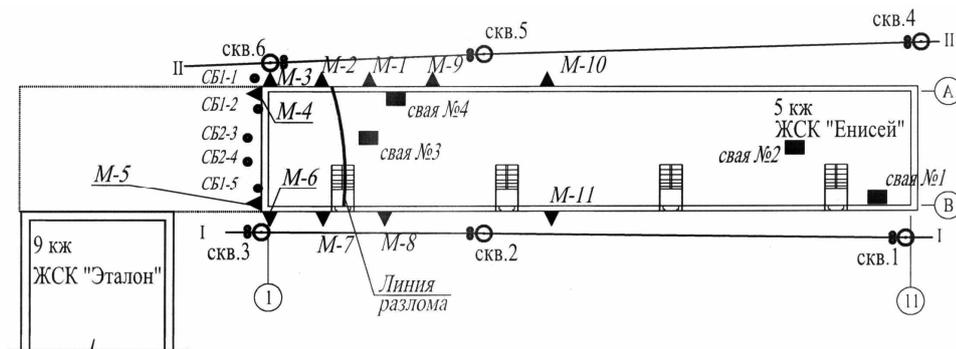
Ситуационный план: ▲ М-1 — места установки осадочных марок; ● СБ1-1 — места расположения буровых свай; ○ скв. 1 — места размещения инженерно-геологических выработок и испытаний грунтов прессиомером; ■ — места испытаний забитых свай в ростверке
